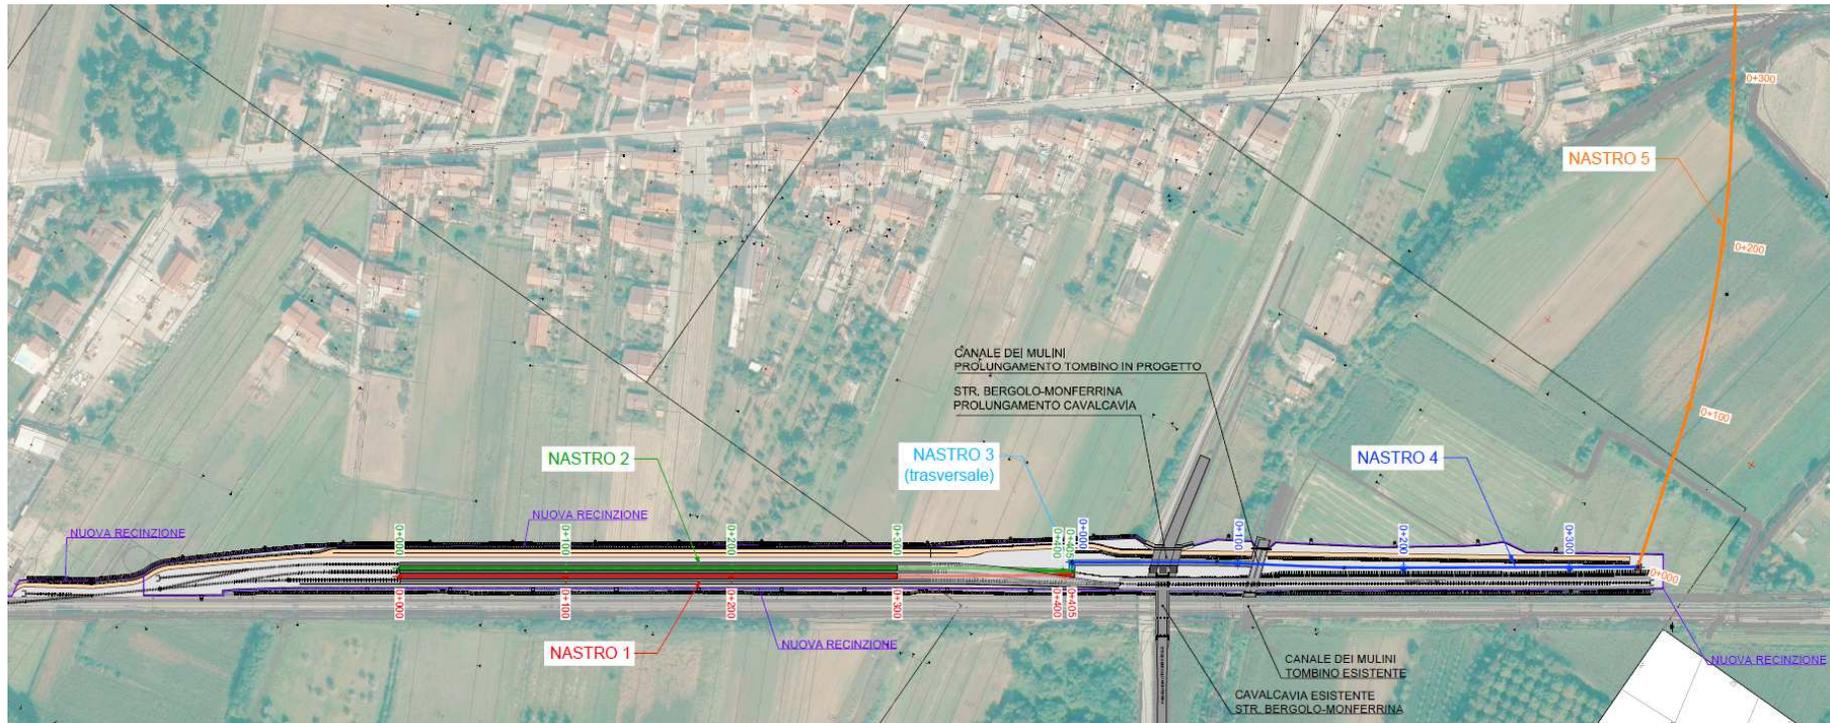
Stralcio planimetrico della zona di scarico su nastro
